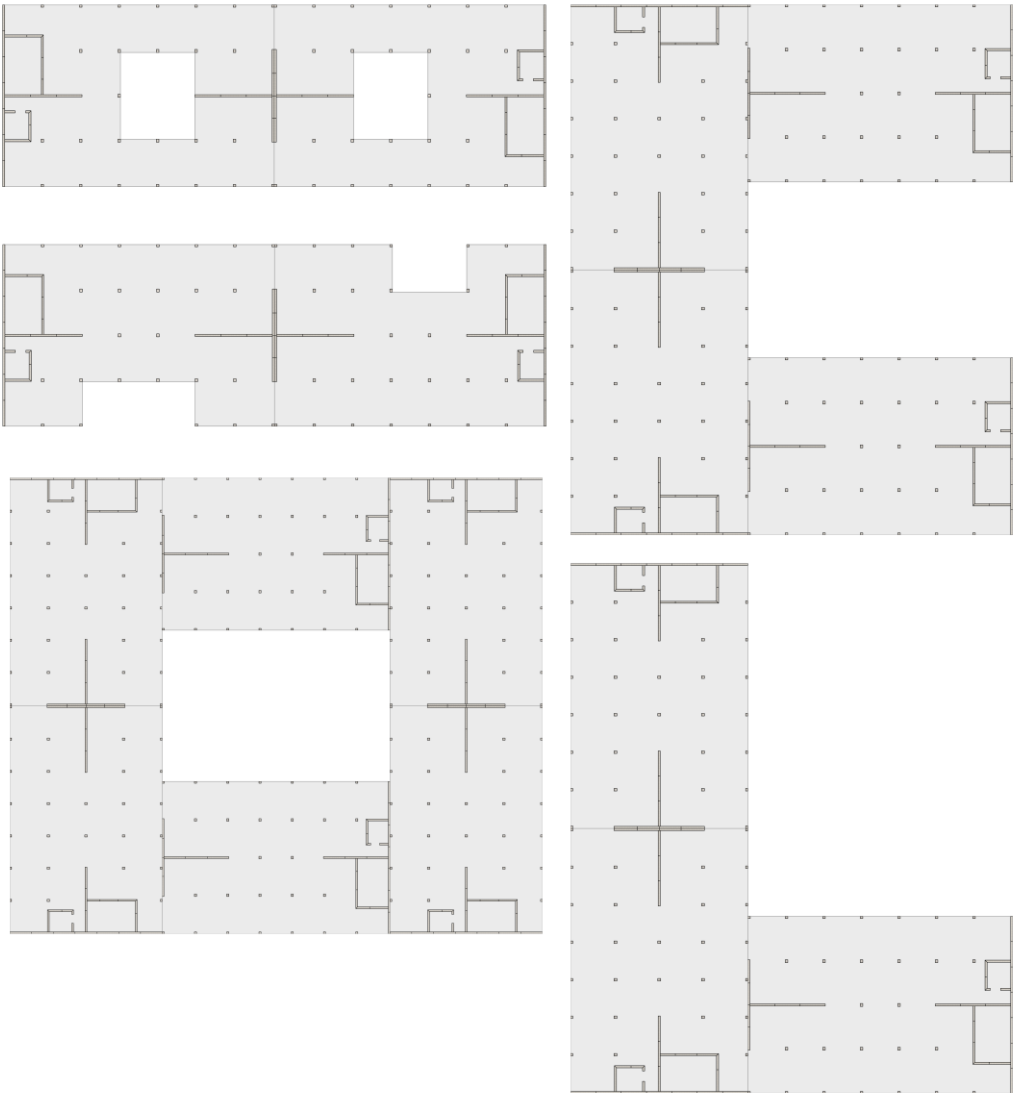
Mögliche Grundrissvarianten für Konzept 1
